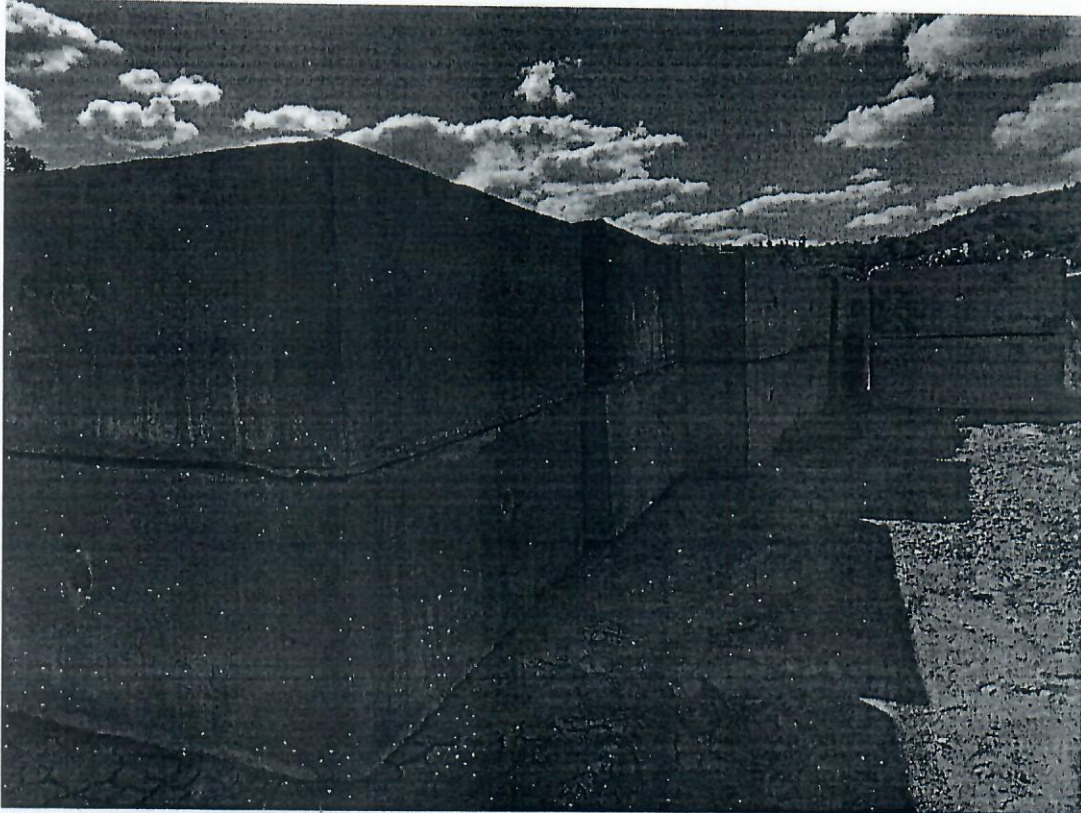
GALERIA DE CONCRETO CELULAR NÃO EXECUTADO
